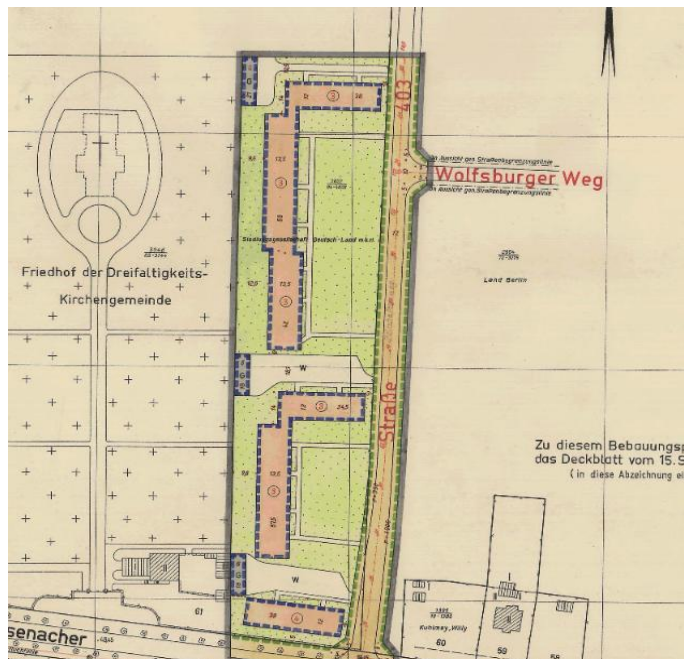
Ausschnitt Bebauungsplan XIII-46 Stand 1959
